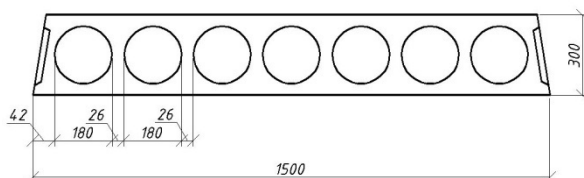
Компоновка пустотной плиты перекрытия
